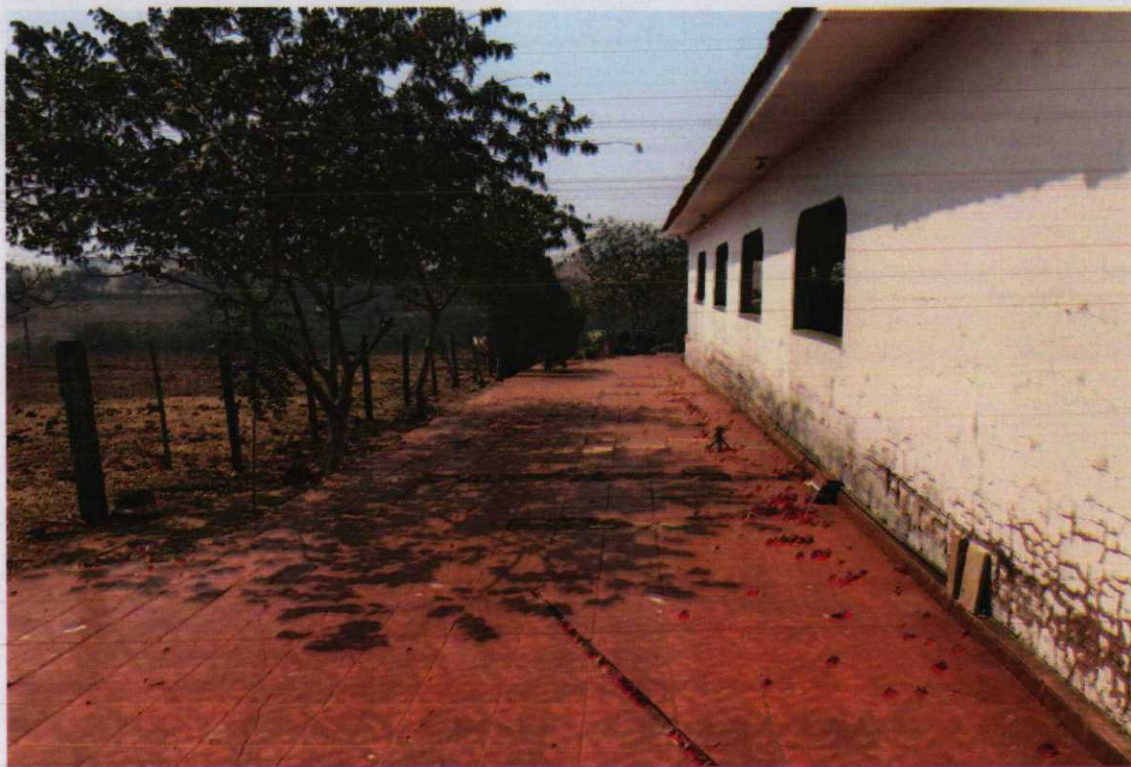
Vista de área ladrilhada ao lado da casa sede.
